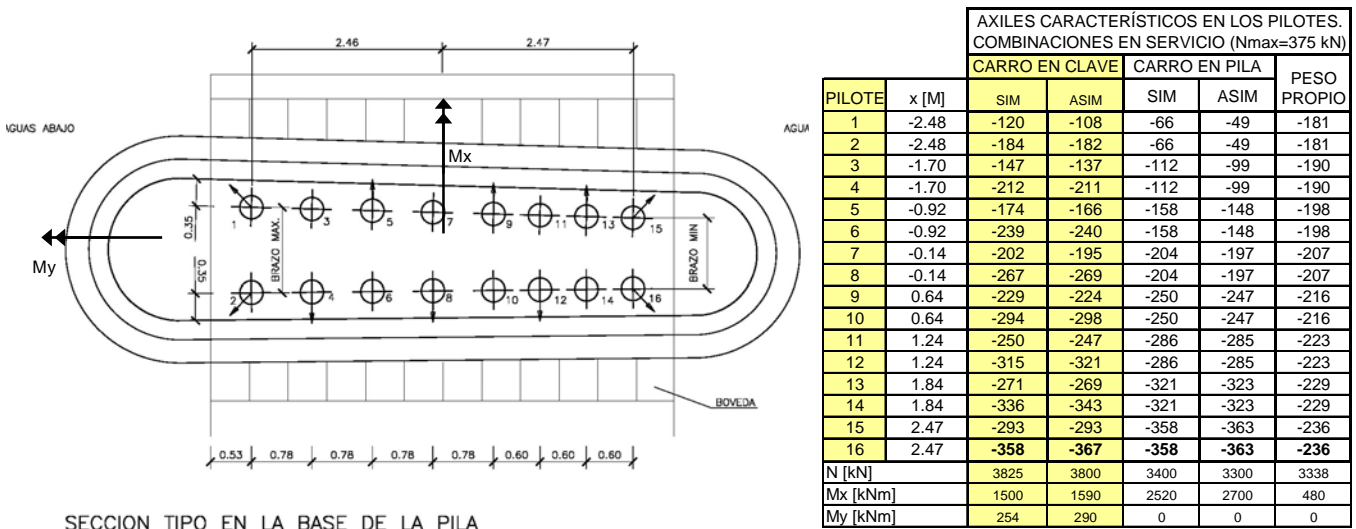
Sección del refuerzo típico en pilas y axiles en micropilotes
